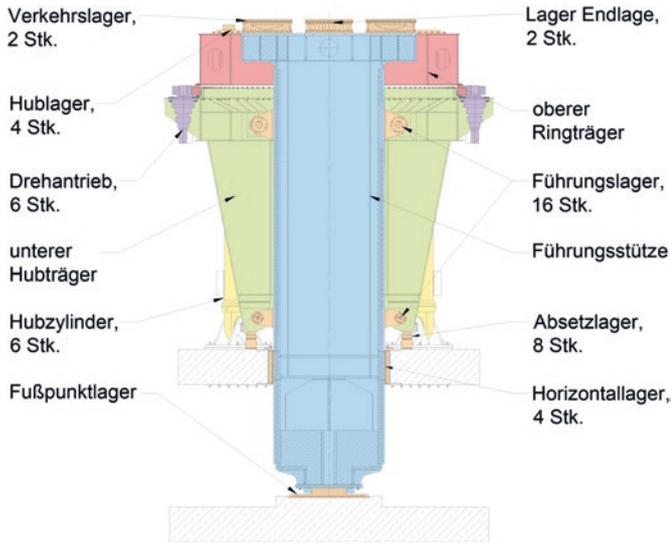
Schnitt durch die Führungsstütze und die Maschinenteknik zur Bewegung der Brücke [10]
